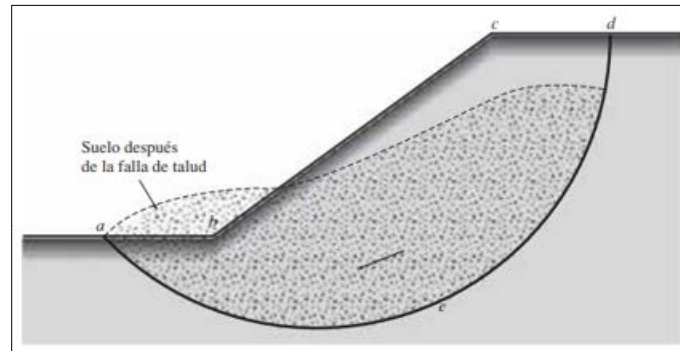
Falla de talud. Fuente: Fundamentos de ingeniería geotécnica, Braja M. Das [23].
